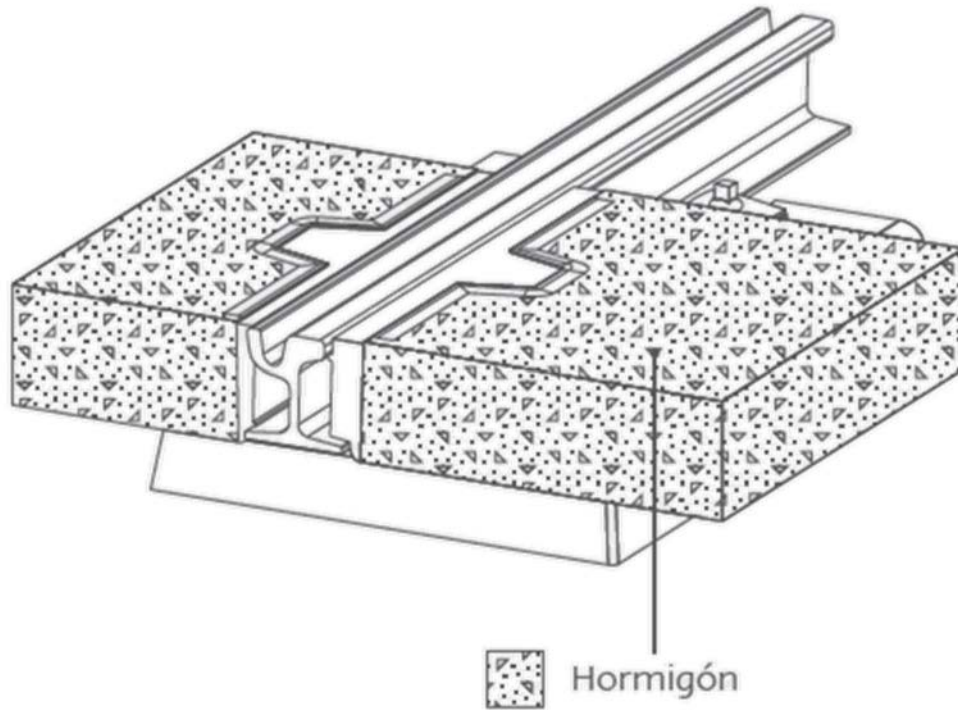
Instalación con revestimiento de hormigón, en cruce con circulación rodada (con perfil metálico de protección)
